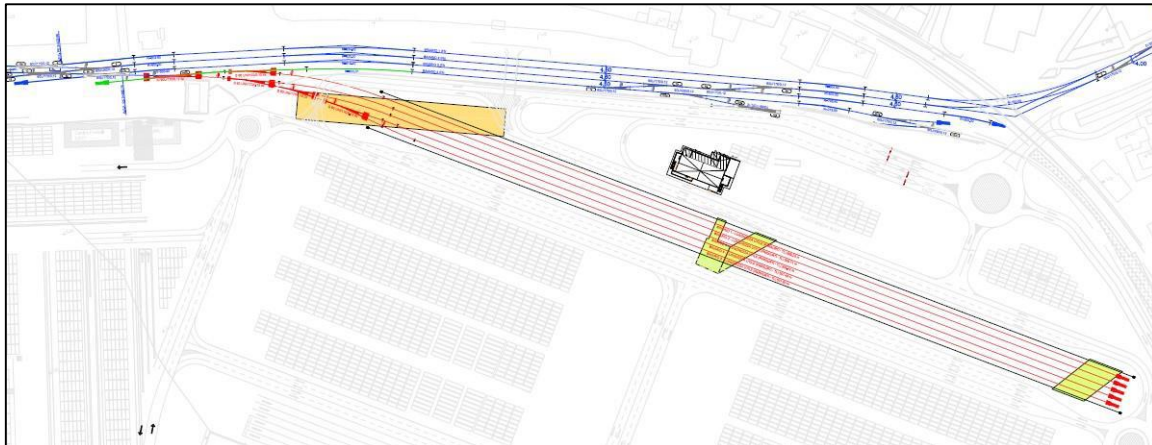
Stralcio planimetrico area di intervento con l'indicazione del nuovo fascio binari
